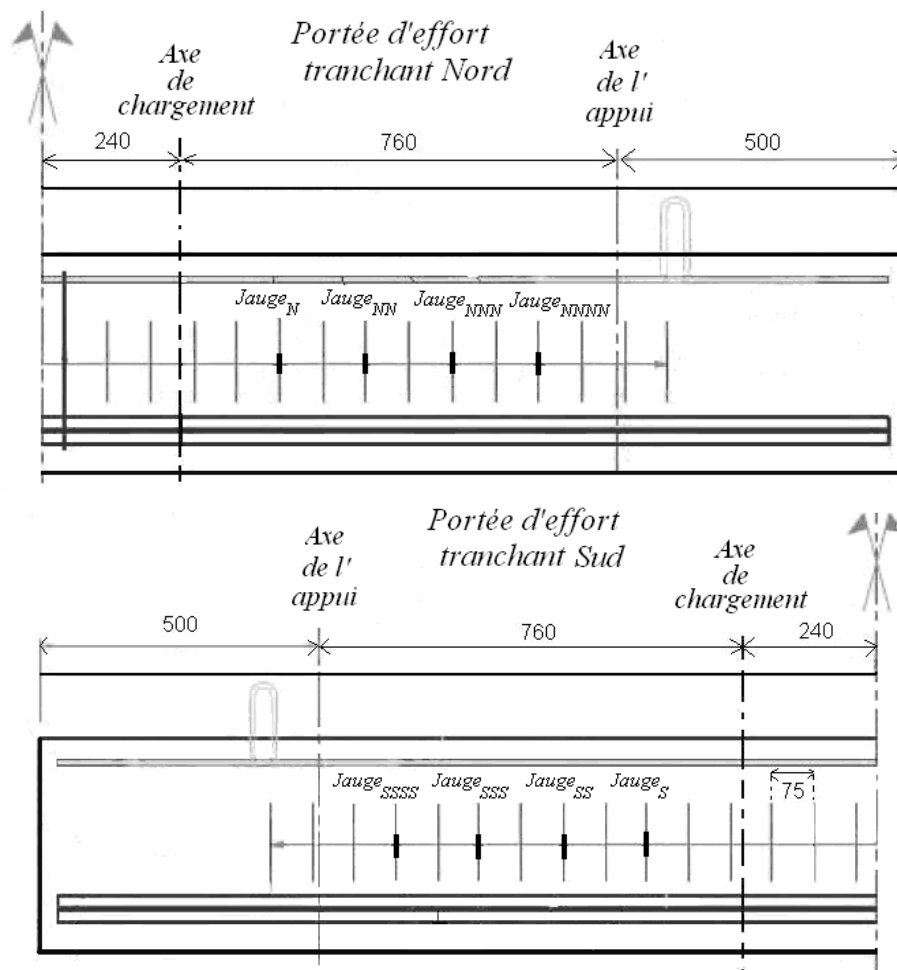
Position des armatures transversales instrumentées (dimensions en mm) : Poutres BFUP-B-RC-WS et BFUP-F-RC-WS
